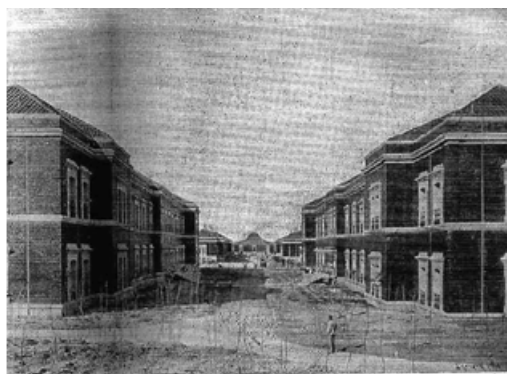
y 12. Manuel Cano, Hospital central de la Defensa hoy Gómez Ulla, Madrid.1865 (imagen: Revista La Ilustración Española y Americana, 22 de julio de 1886. Fuente BNE)
